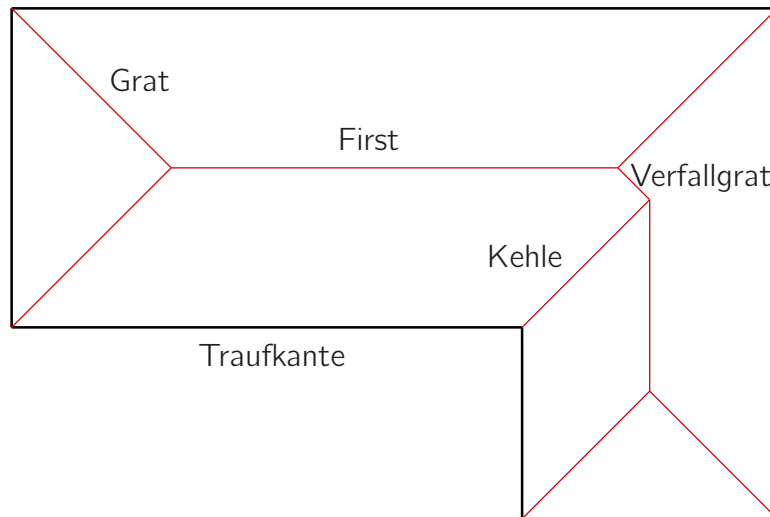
Grundriss eines Daches mit verschiedenen Dachkanten
